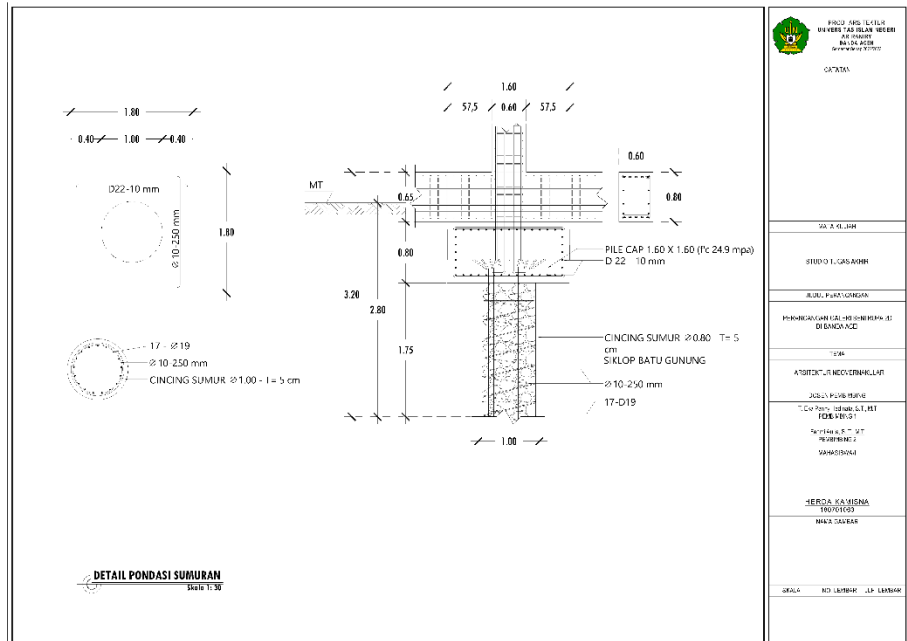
33 Denah Rencana Pondasi Sumuran
